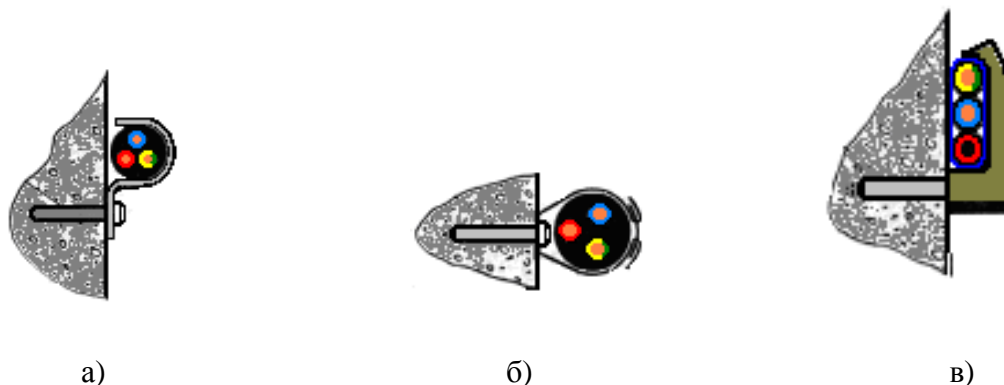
Способы крепления кабеля непосредственно по строительному основанию: а) крепление металлической скобой; б) крепление металлической полоской и пряжкой; в) крепление пластмассовой скобкой.
